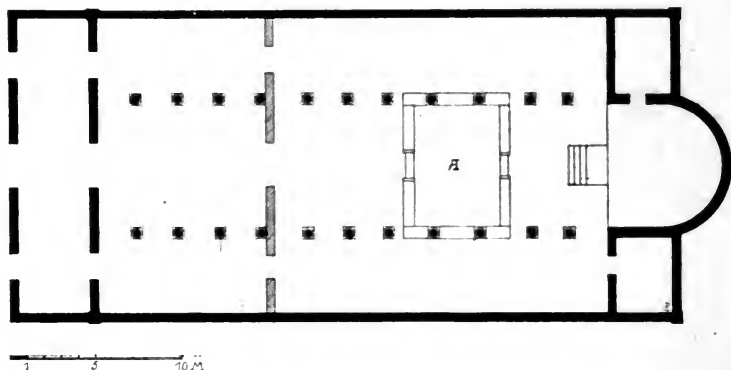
PLAN DE LA BASILIQUE DE KHERBET GHUIDRA.
